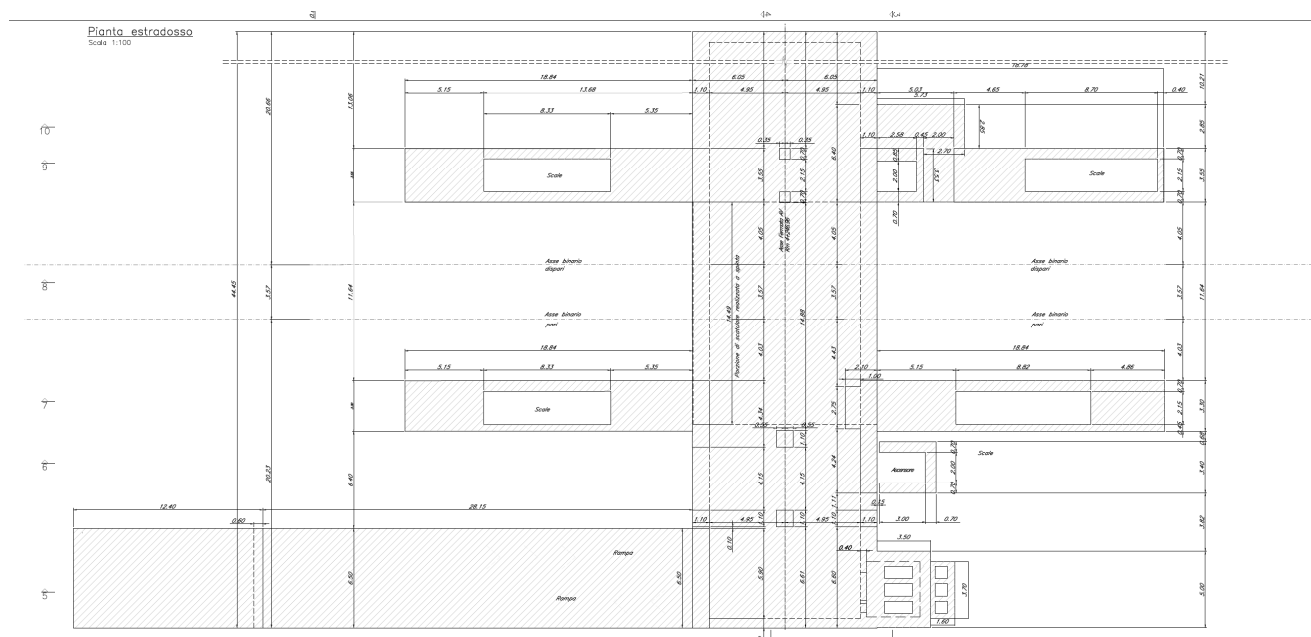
Pianta sottopasso e rampe e nuclei ascensore
